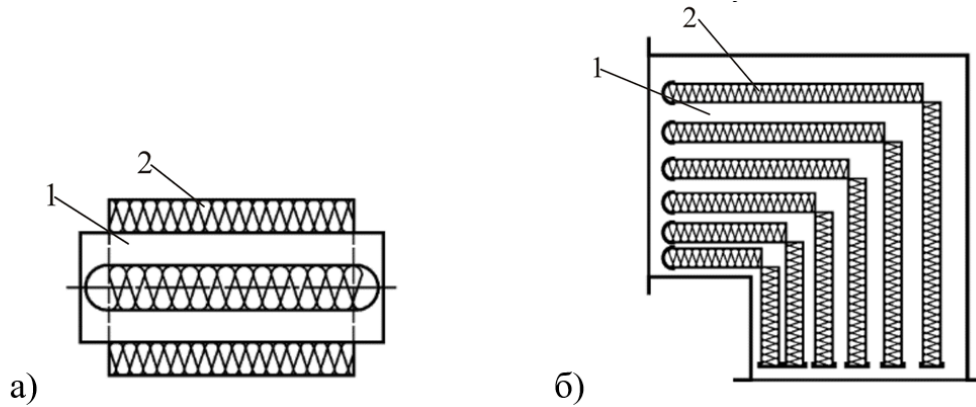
Глушитель: а) круглый глушитель с концентрическим кожухом; б) коленчатый глушитель. 1 – вентиляционный канал, 2 – звукопоглощающий материал.
